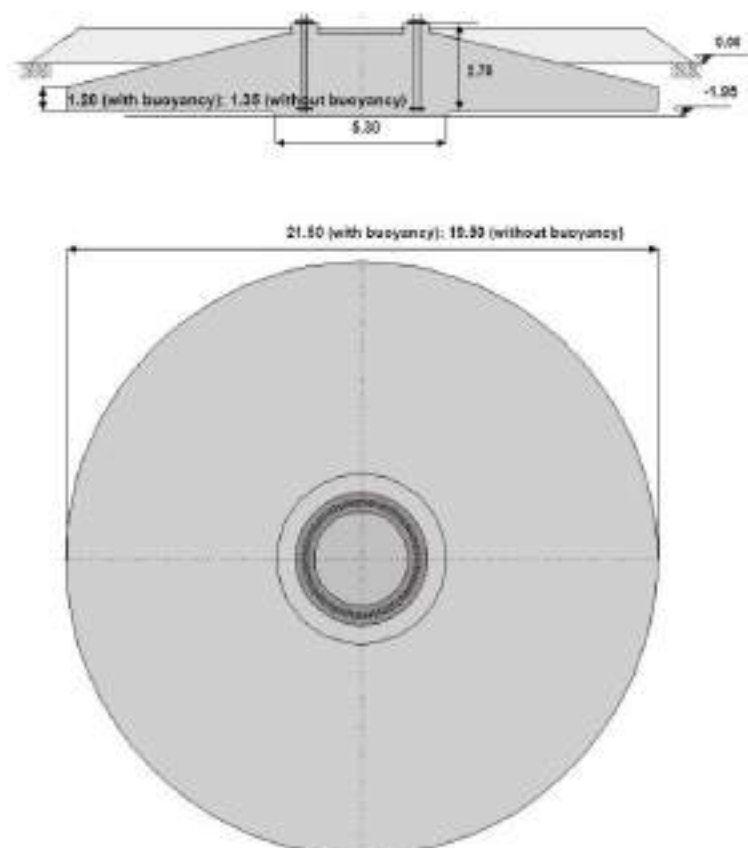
Coupe de principe d'une fondation (source : Nordex, 2017)
